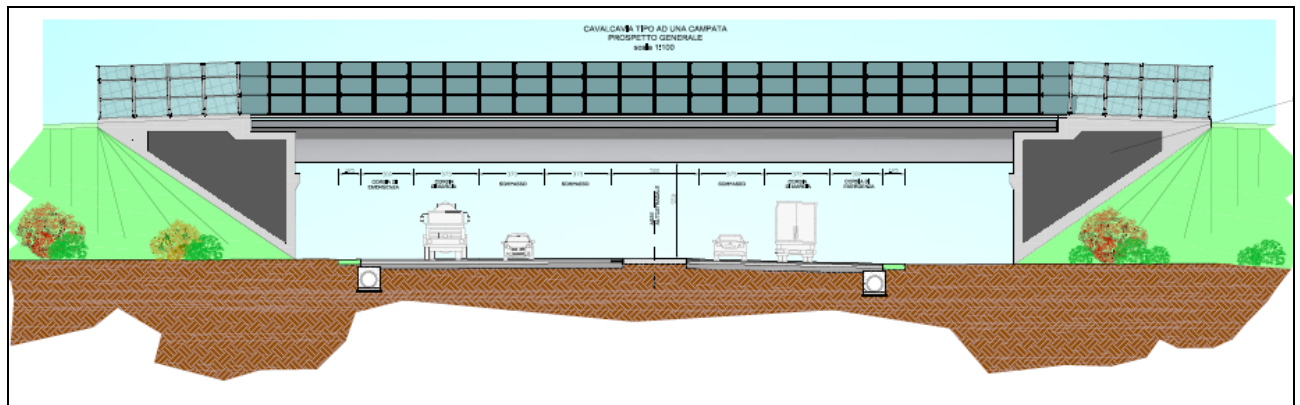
/5 Prospetto tipologico e vista prospettica dei cavalcavia in progetto
